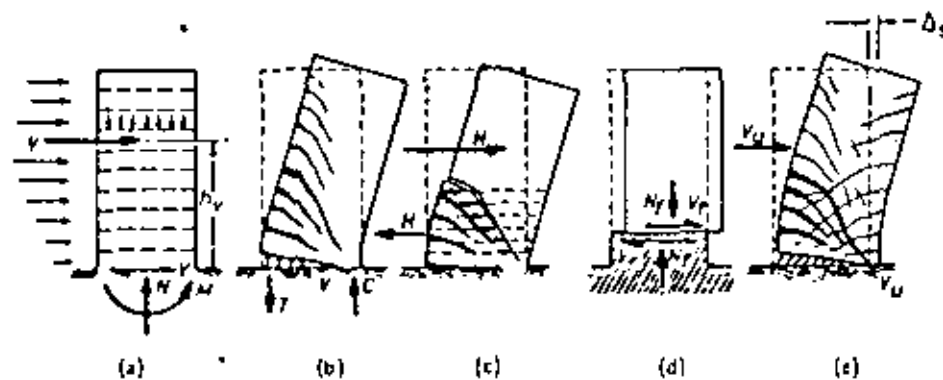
Modos de falla en un muro de cortante en voladizo, de concreto reforzado, cargado lateralmente.
